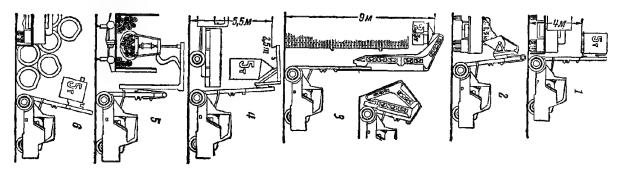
Схема работы автопогрузчика с различными рабочими приспособлениями: t-c выяками; s-c ковшом; s-d-c краном; s-c захватом.
